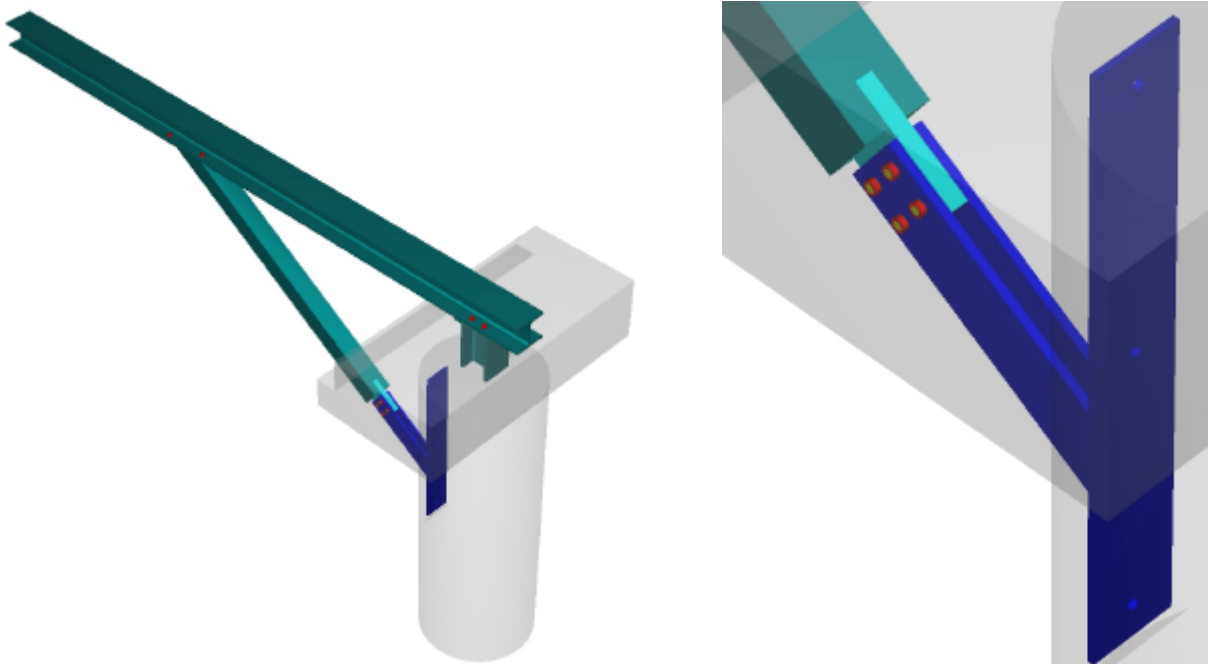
3D-CAD Modell der Struktur entwickelt aus dem 2D-Konstruktionsplan mit Detailausschnitt des Stoßes
